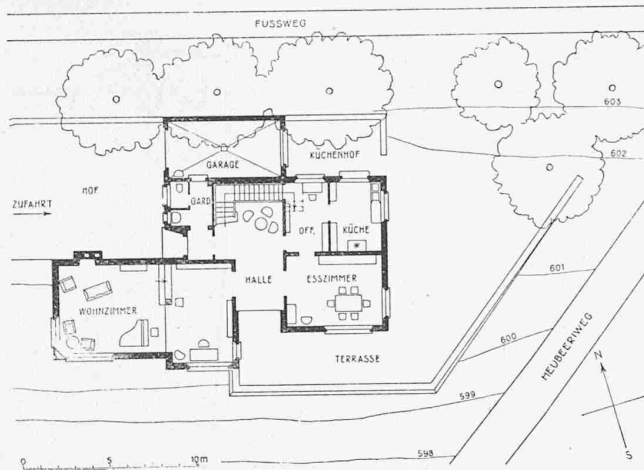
Erdgeschoss-Grundriss mit Situation. — 1 : 400.
